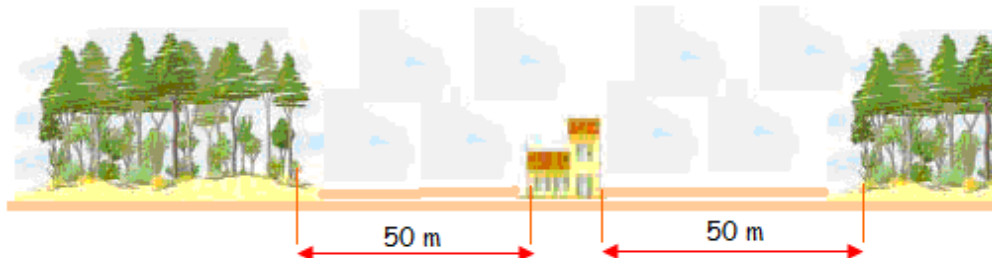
Asigurarea distanțelor de siguranță între construcții și zona forestieră.
